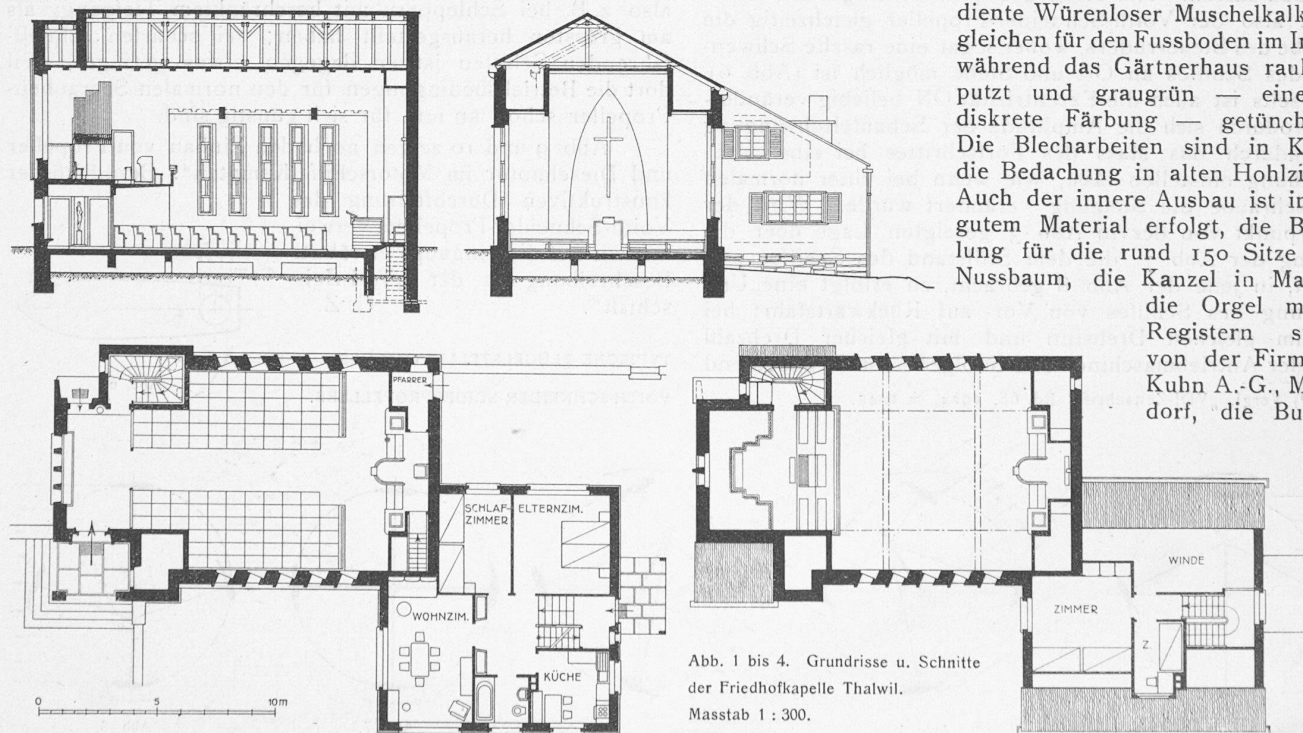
bis 4. Grundrisse u. Schnitte der Friedhofskapelle Thalwil. Masstab 1 : 300.
